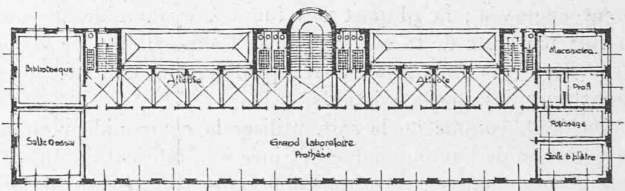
Plan du 2^e étage. — 1 : 800.
